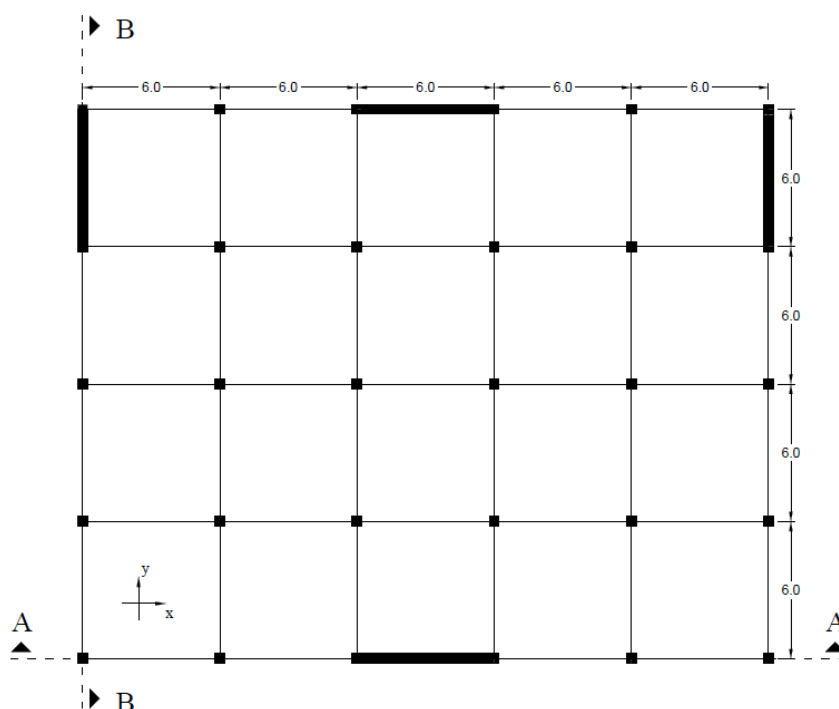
Esquema em planta do exemplo de uma estrutura contraventada
